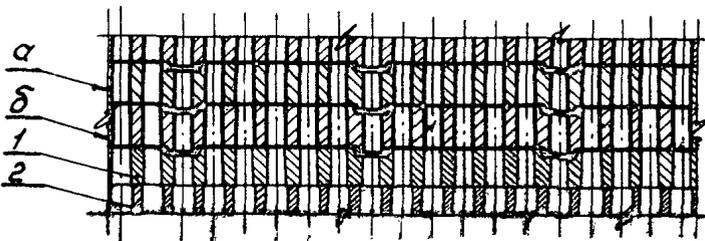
Кладка насадки из шестигранных насадочных изделий: а - четный ряд; б - нечетный ряд; 1 - насадочные изделия из жаропрочного чугуна; 2 - поднасадочное устройство
